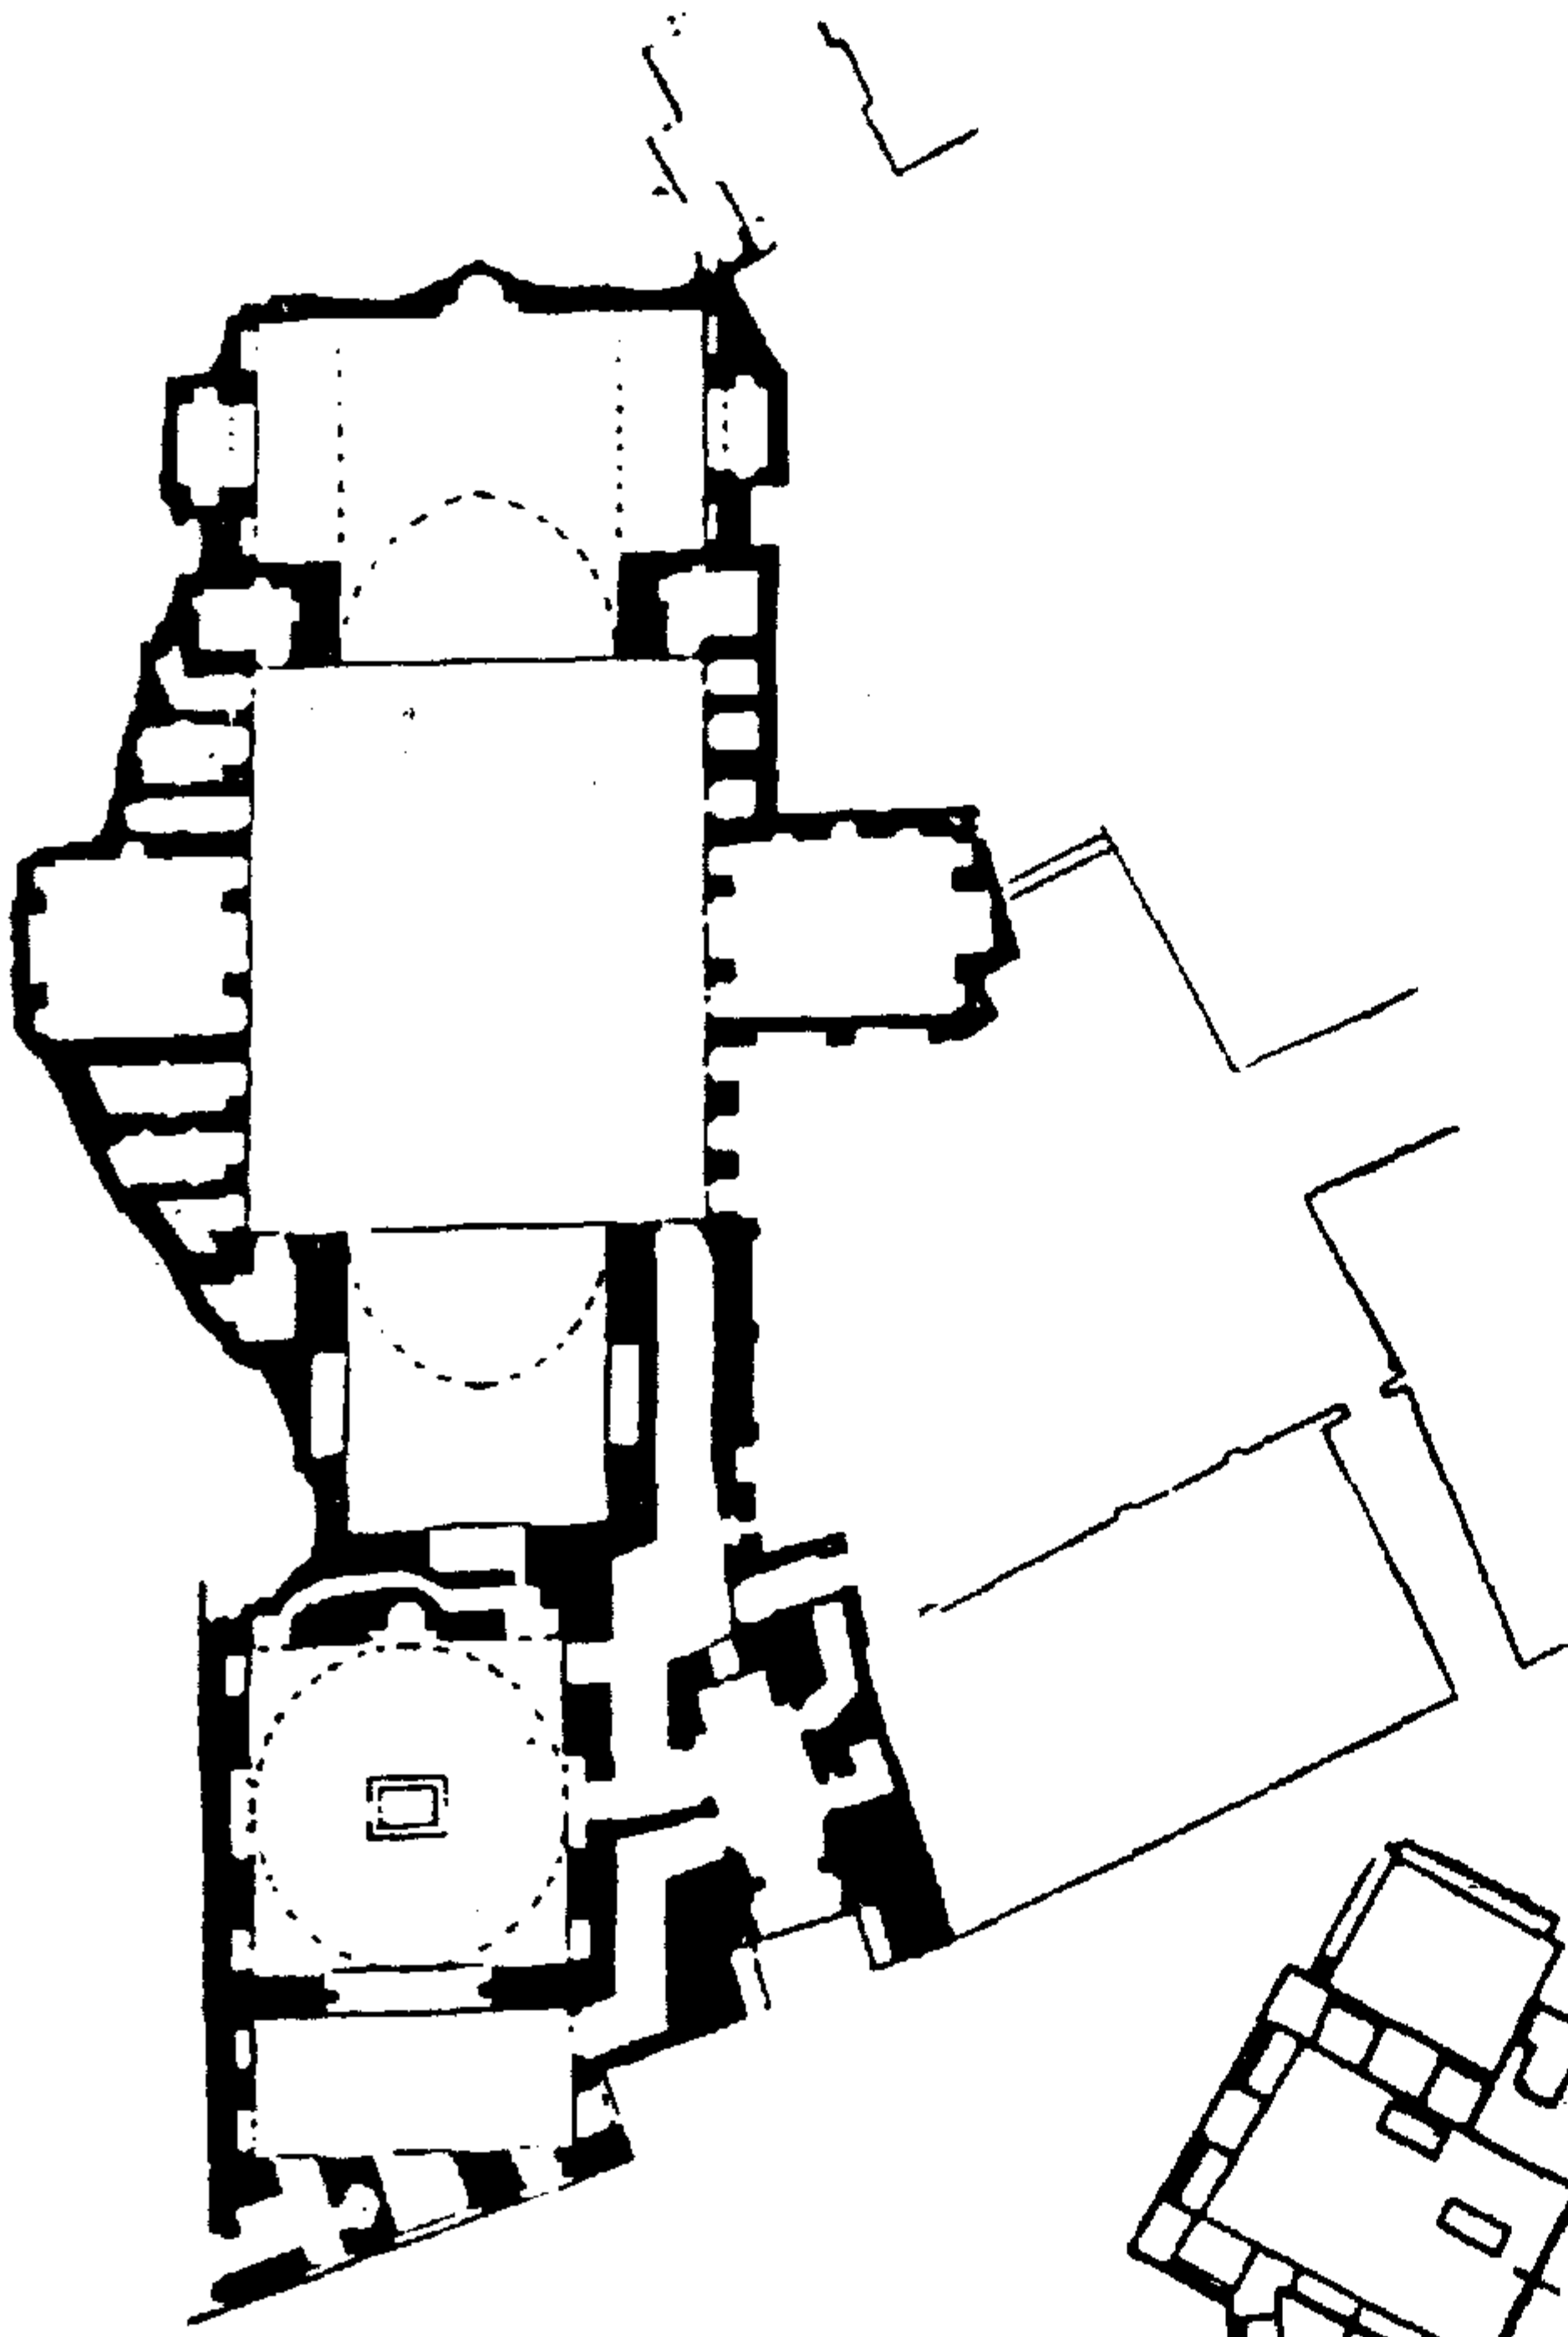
مسقط أفقي للمدرسة الصالحية بالقاهرة.
